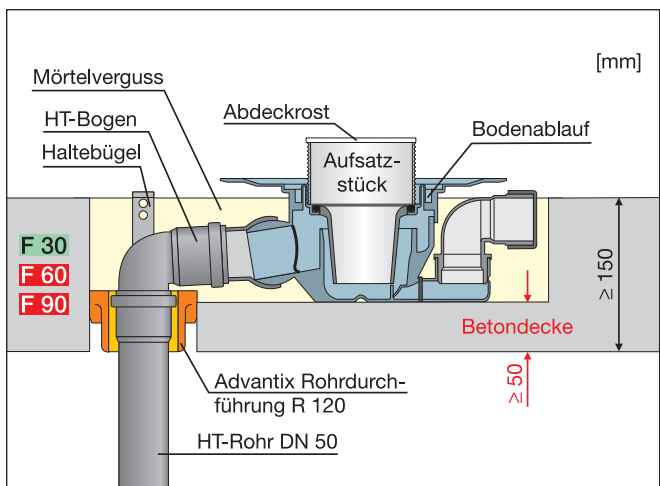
Advantix Rohrdurchführung R 120 in Kombination mit einem in der Decke eingebauten Bodenablauf und angeschlossenem Kunststoffrohr.
